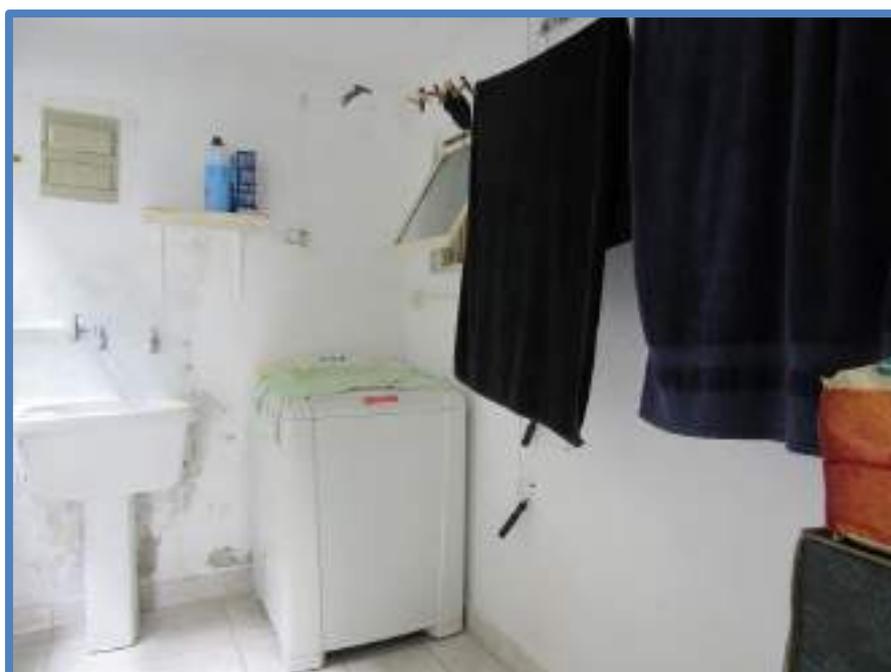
Casa, Primeiro Subsolo, Área de Serviço.
